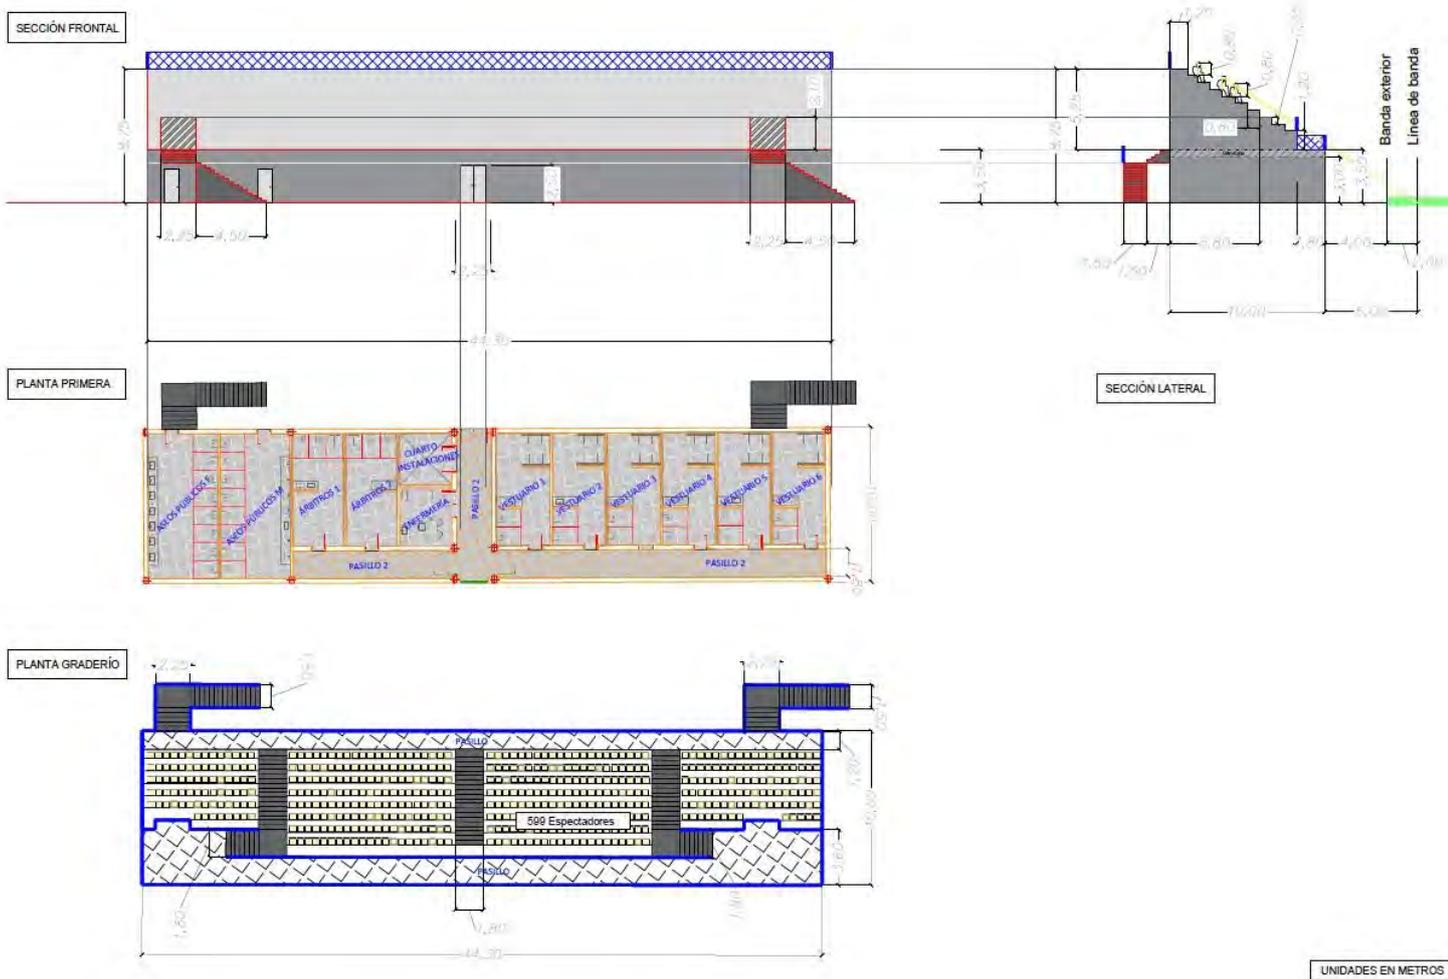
Vista planta primera y graderío y sección frontal y lateral
